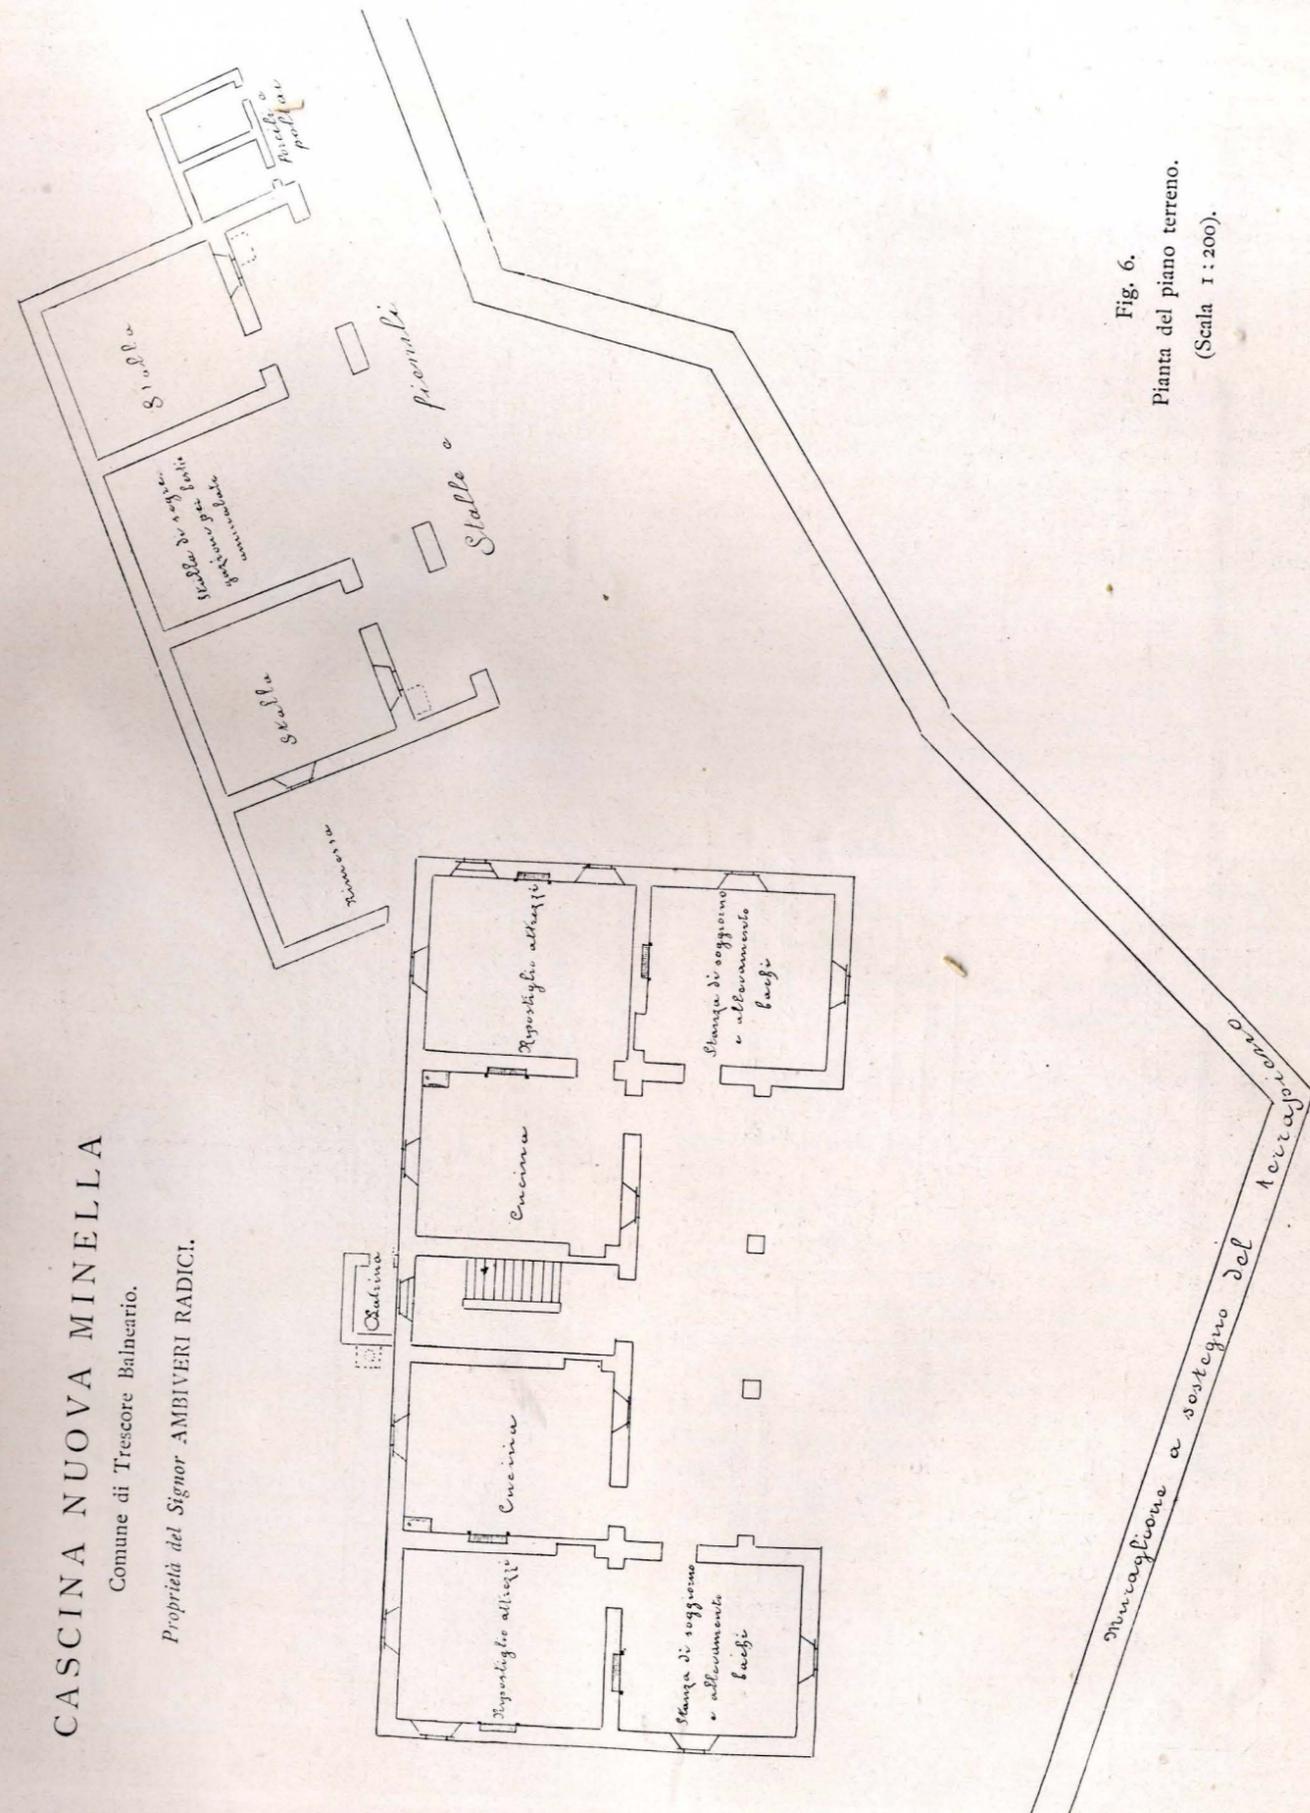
Pianta del piano terreno. (Scala 1:200).
